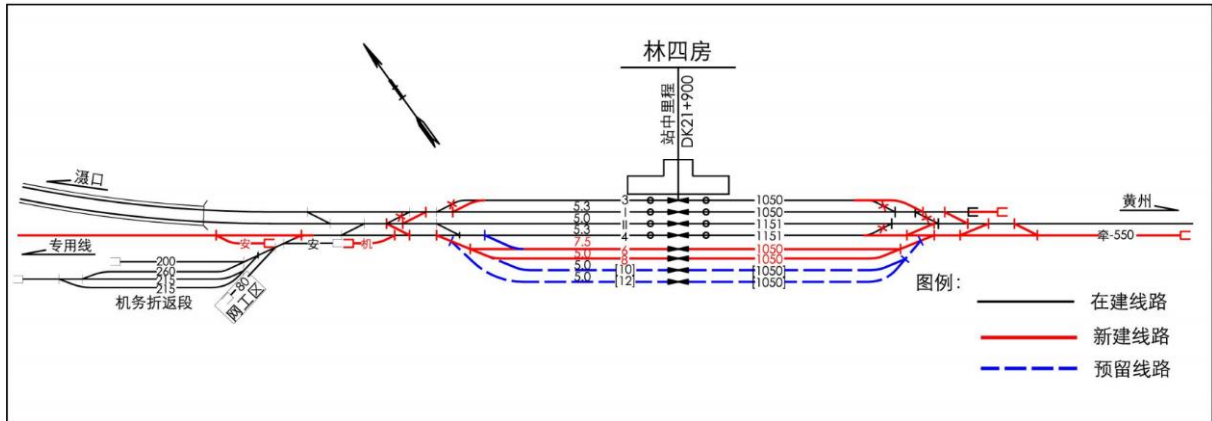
林四房站西咽喉南侧接轨平面布置示意图
